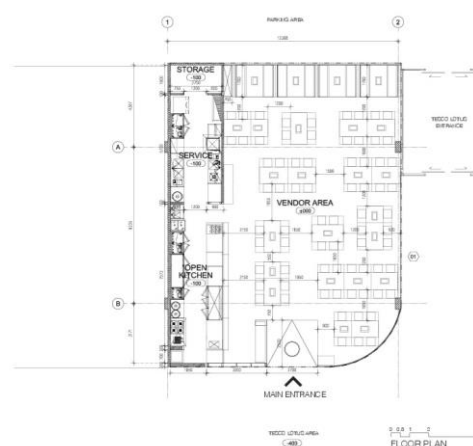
Planta de equipamento do restaurante Coca Grill; Fonte: Archdaily
